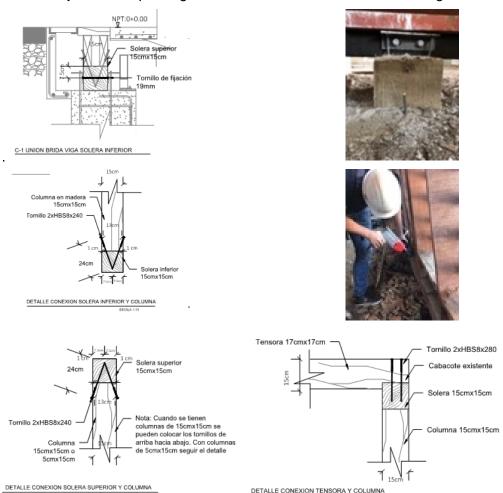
Detalles constructivos de los anclajes con tornillería especial Rothoblass según su uso
